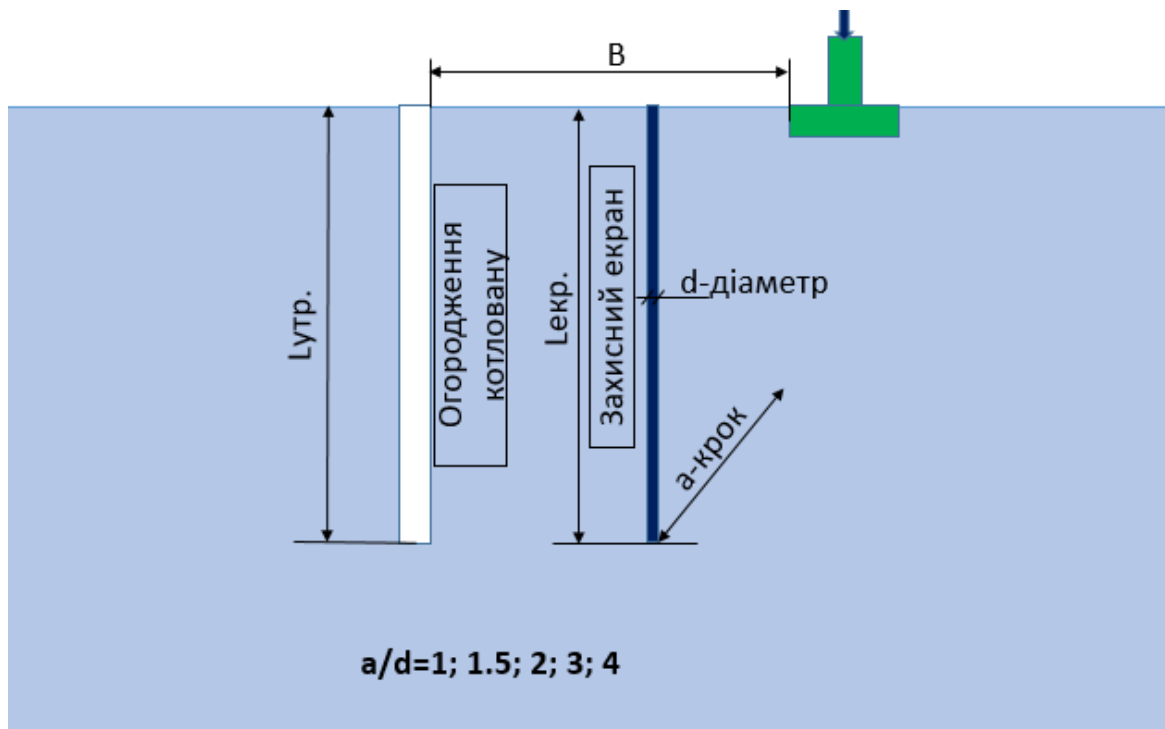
Розрахункова схема при дослідженні відстані між існуючим будинком та котлованом при застосуванні захисного екрану
